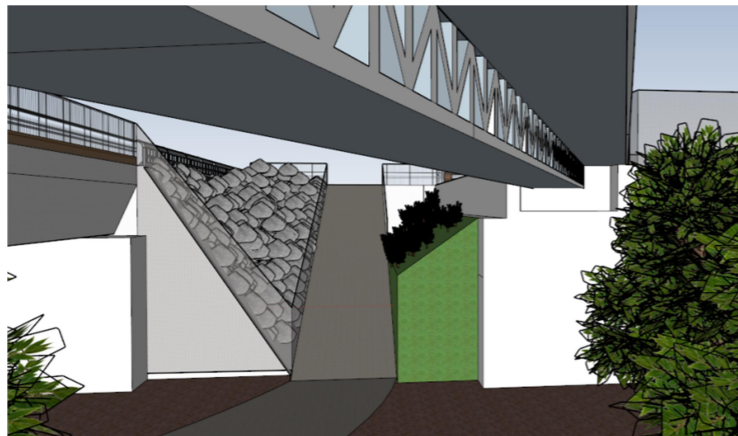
Figura VIII EMPLAZAMIENTO DE L ESTRIBO NORTE
